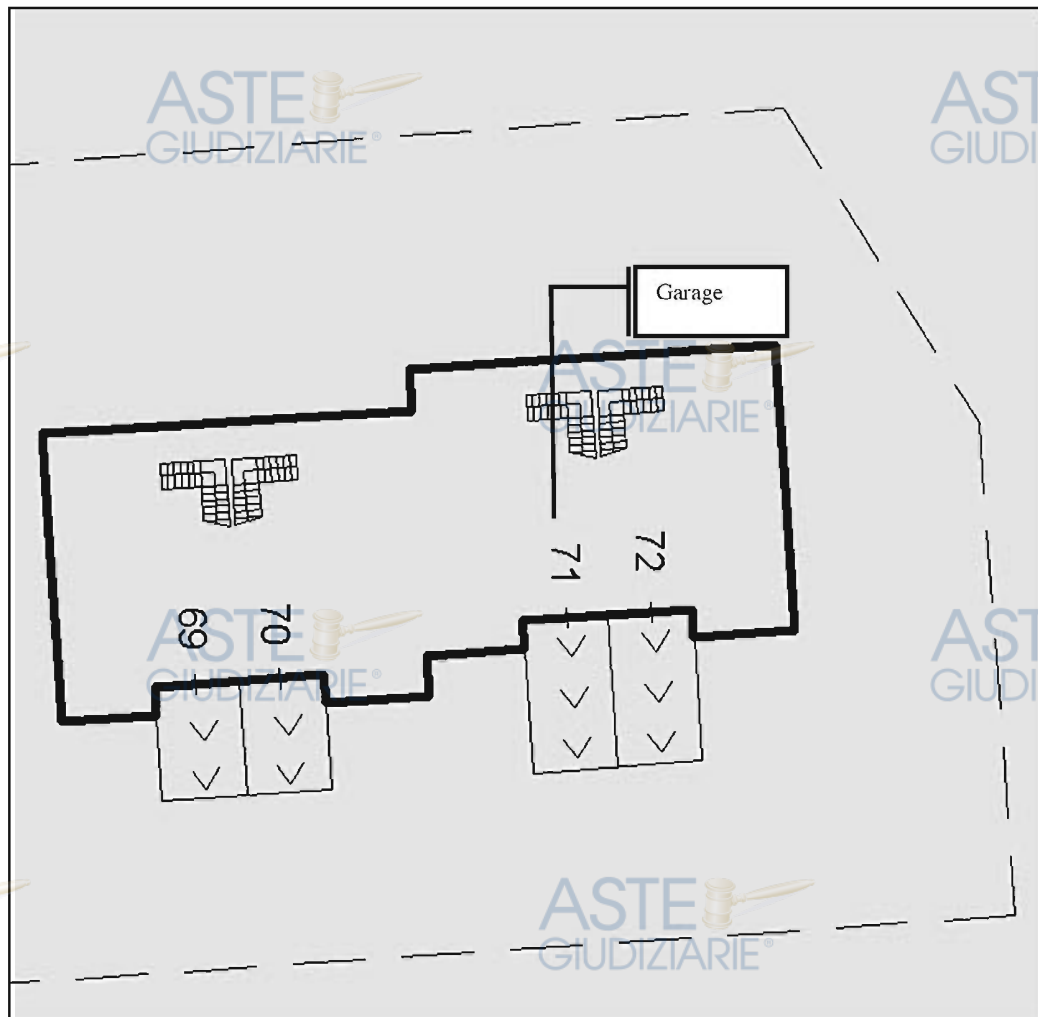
Visualizzazione dell'elaborato planimetrico del piano primo sottostrada- individuazione del sub. 71
